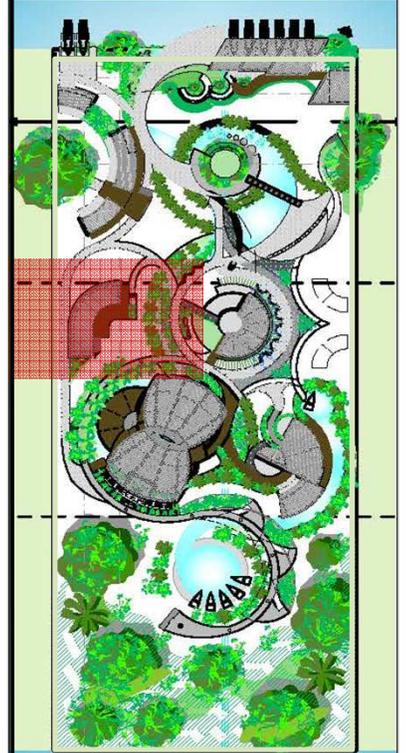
Planta de distribución arquitectónica Administración. 2do Nivel
